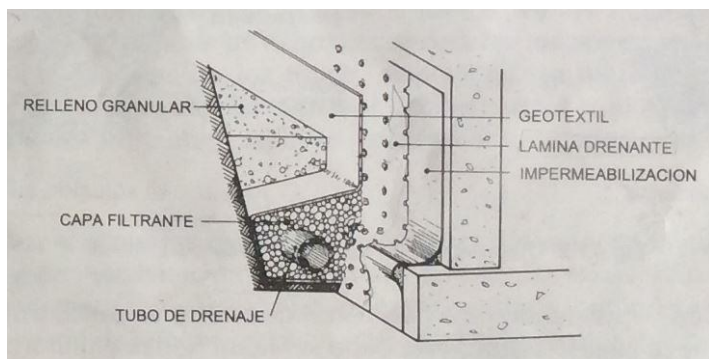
Drenaje perimetral de sótano. J. Calavera 1998
